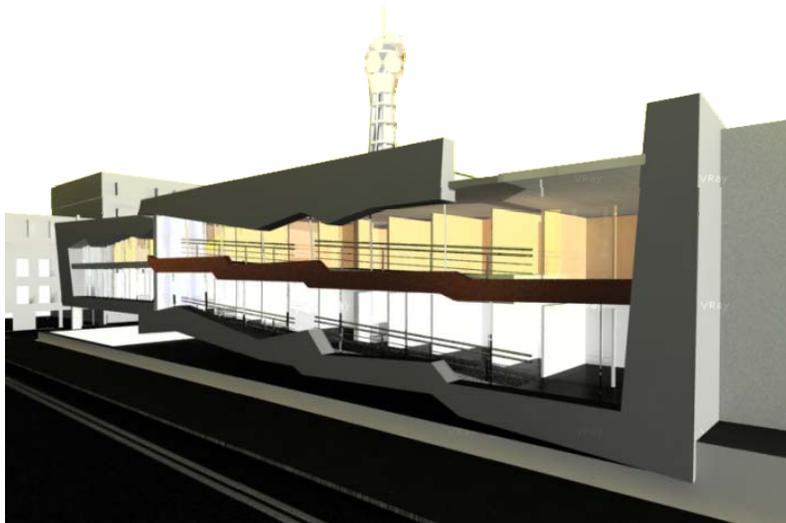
Fachada oriente, control solar a base de parte luces antes de medio día (propuesta de intervención)
